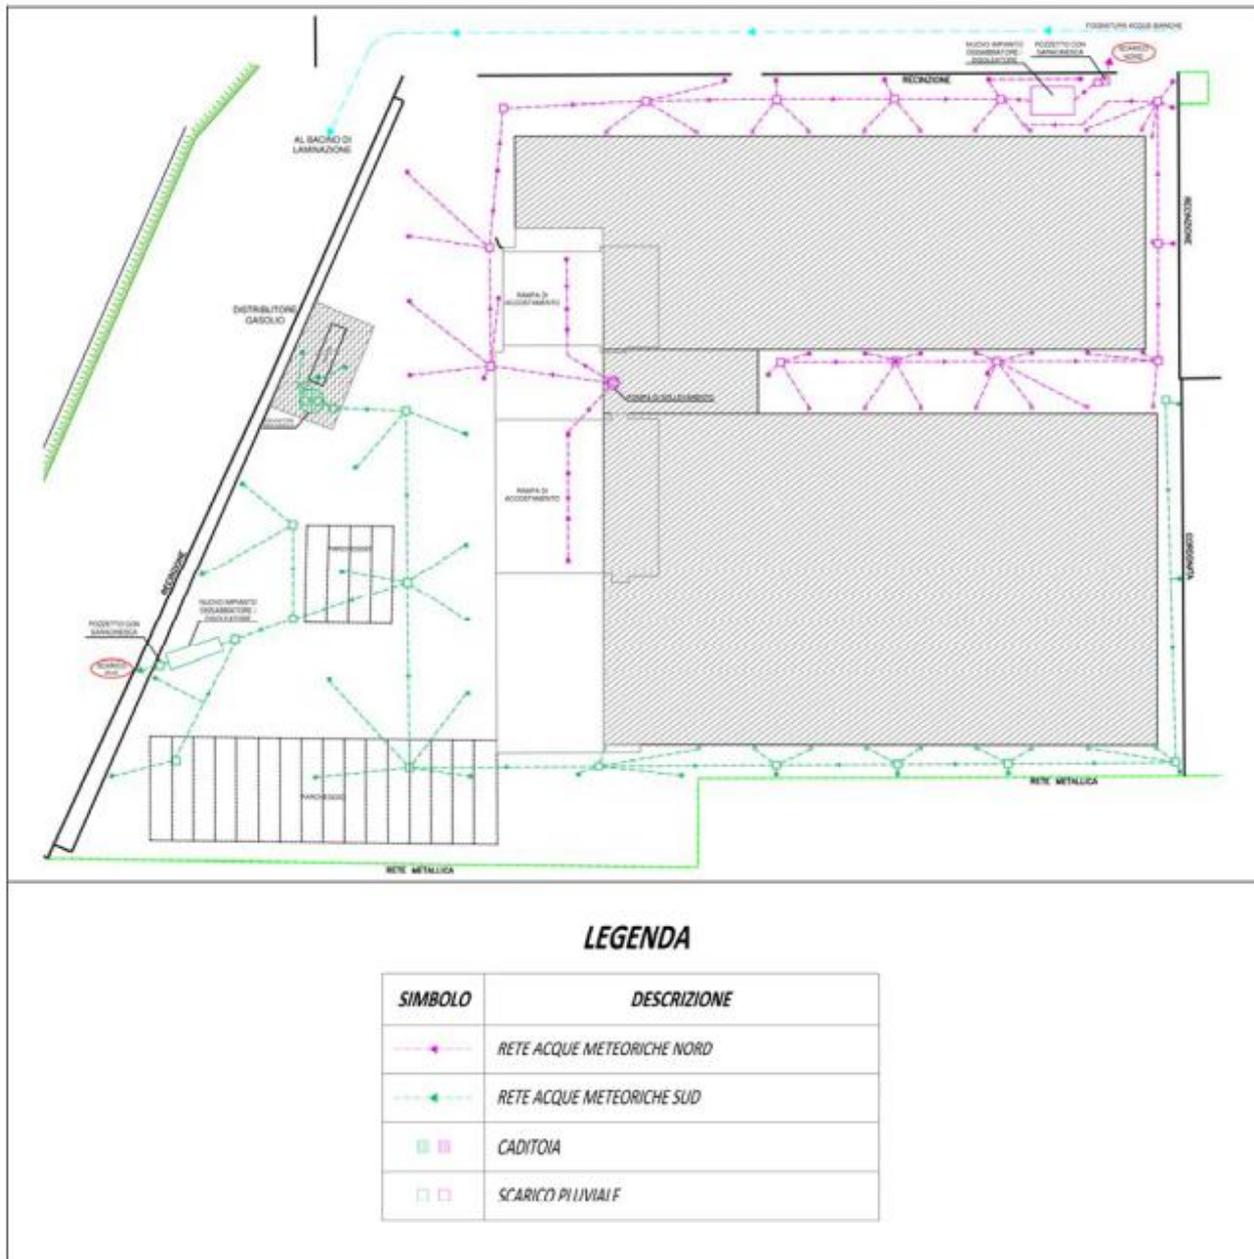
Planimetria della rete di scarico dell'area commerciale – stato di progetto
